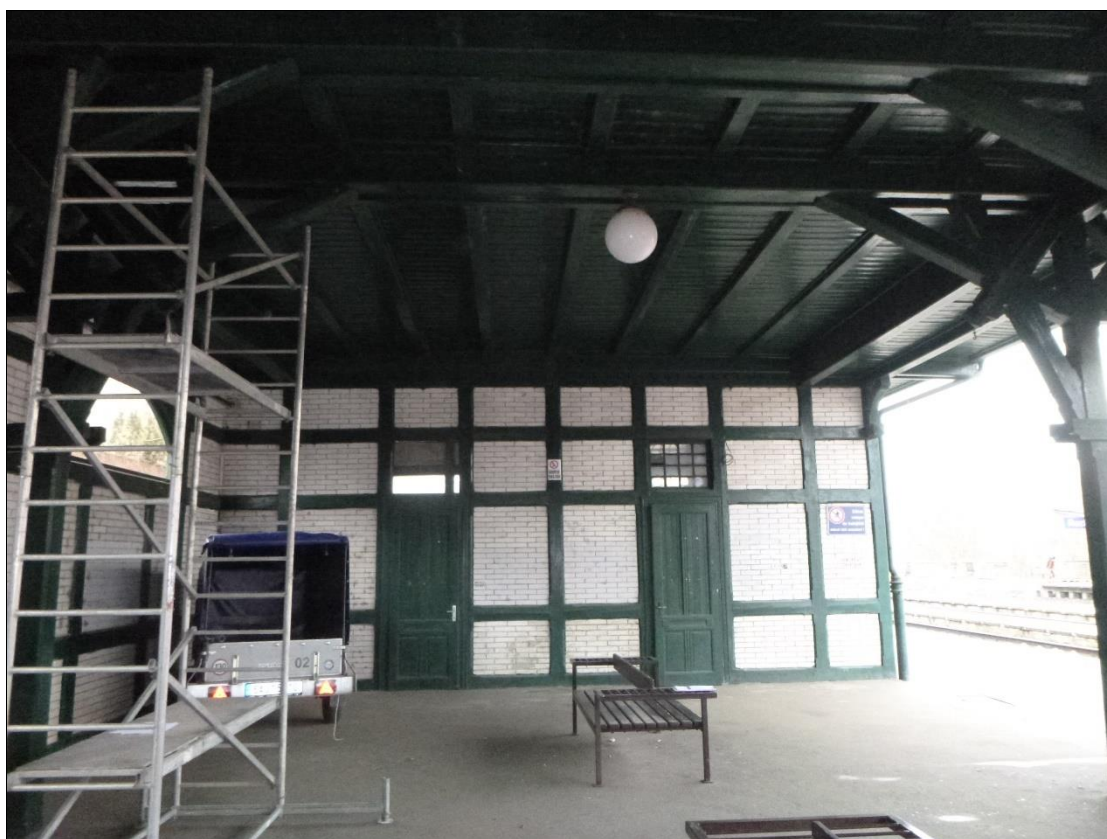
Pohled na zděnou část čekárny, stav zdiva dobrý
